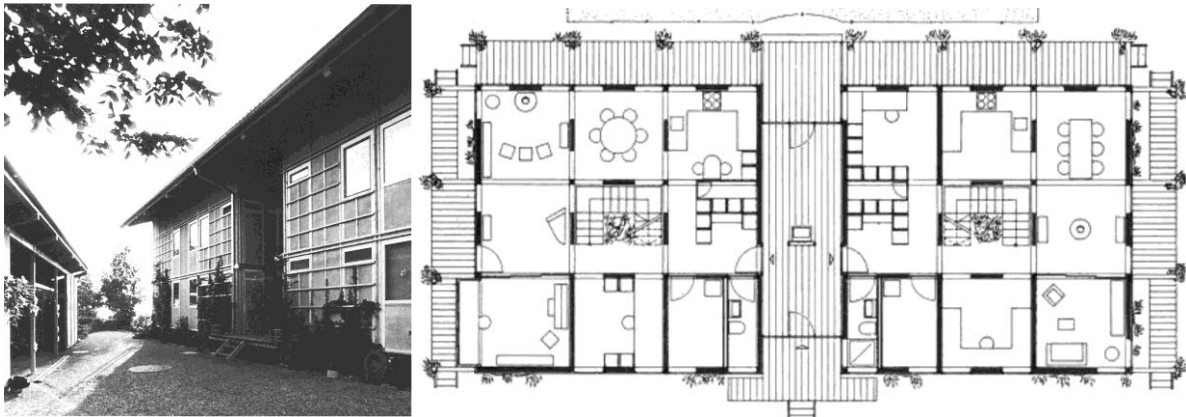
Doppelhaus in Mühleturnen, Bild Eingangsbereich und Grundriss Erdgeschoss / Bauart Architekten und Planer AG
